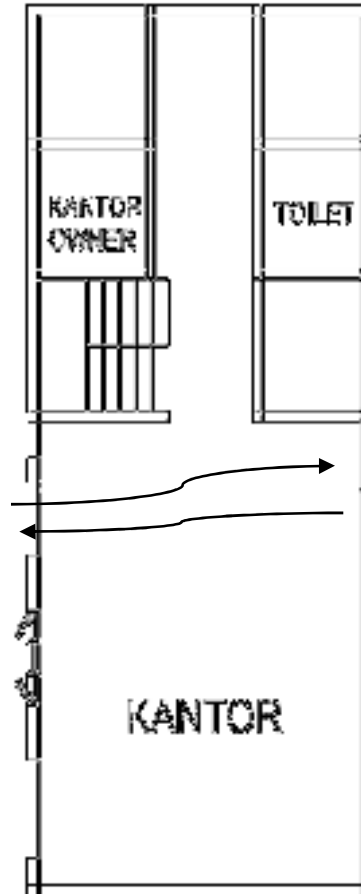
Denah Lantai 1 Dengan Skema Alur Sirkulasi Udara
